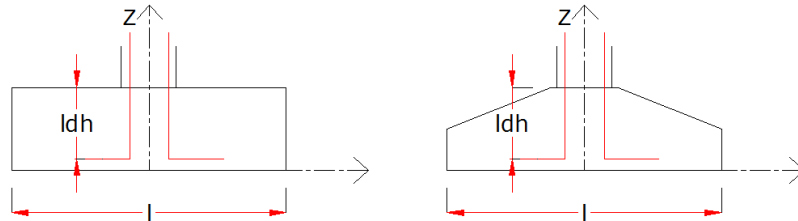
Longitud de anclaje de las barras de columna. Fuente: elaboración propia.
